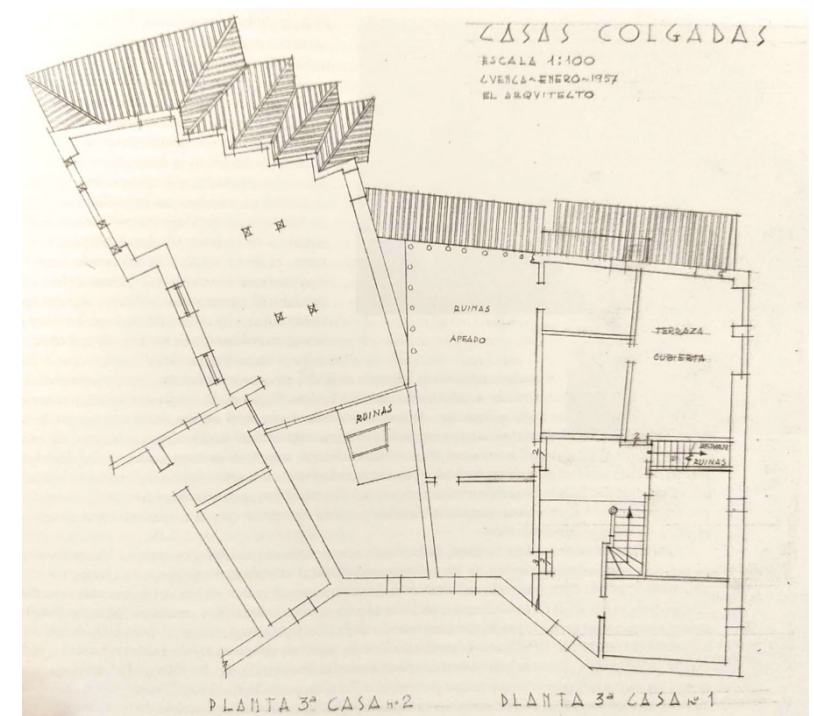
Planta segunda, Casas Colgadas intervención de Fernando Alcántara.
